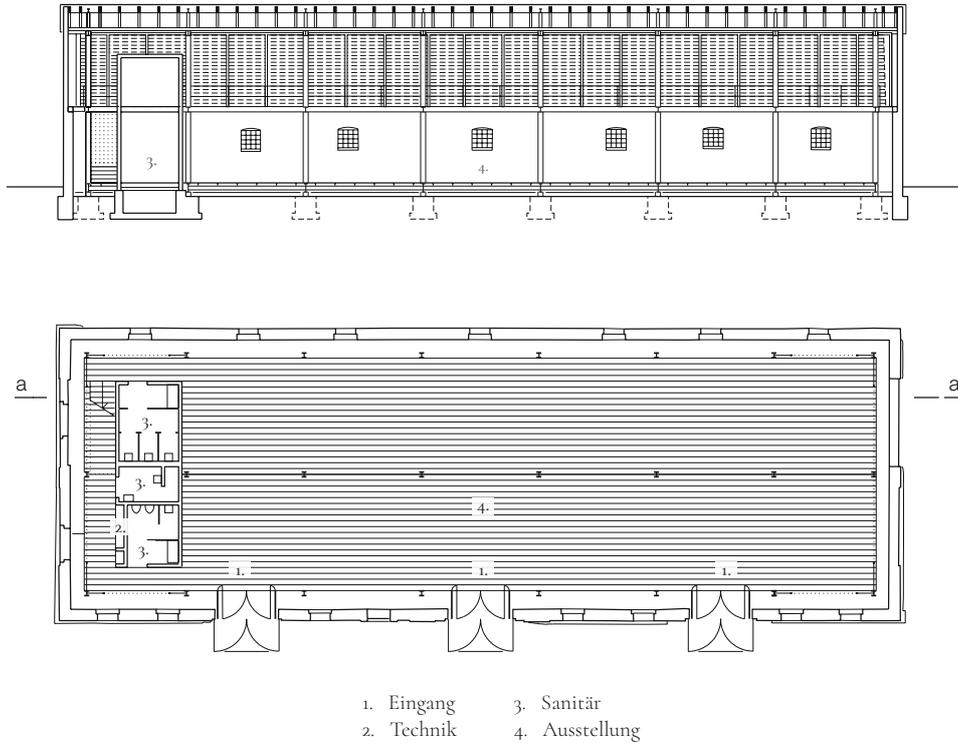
Grundriss und Schnitt des Ausstellungsgebäudes
